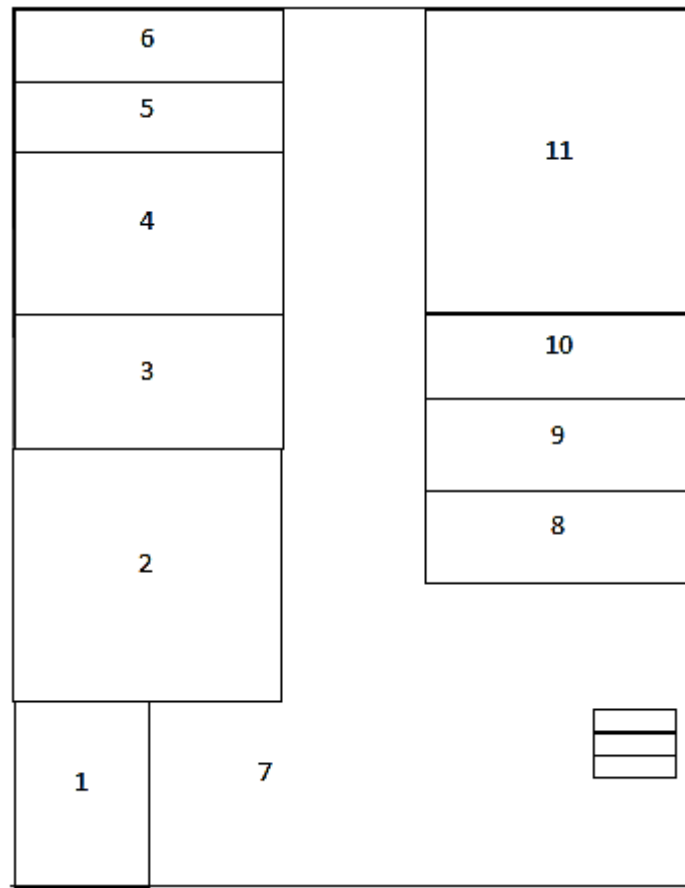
Denah Gedung BPSMB Surakarta Lantai 1
